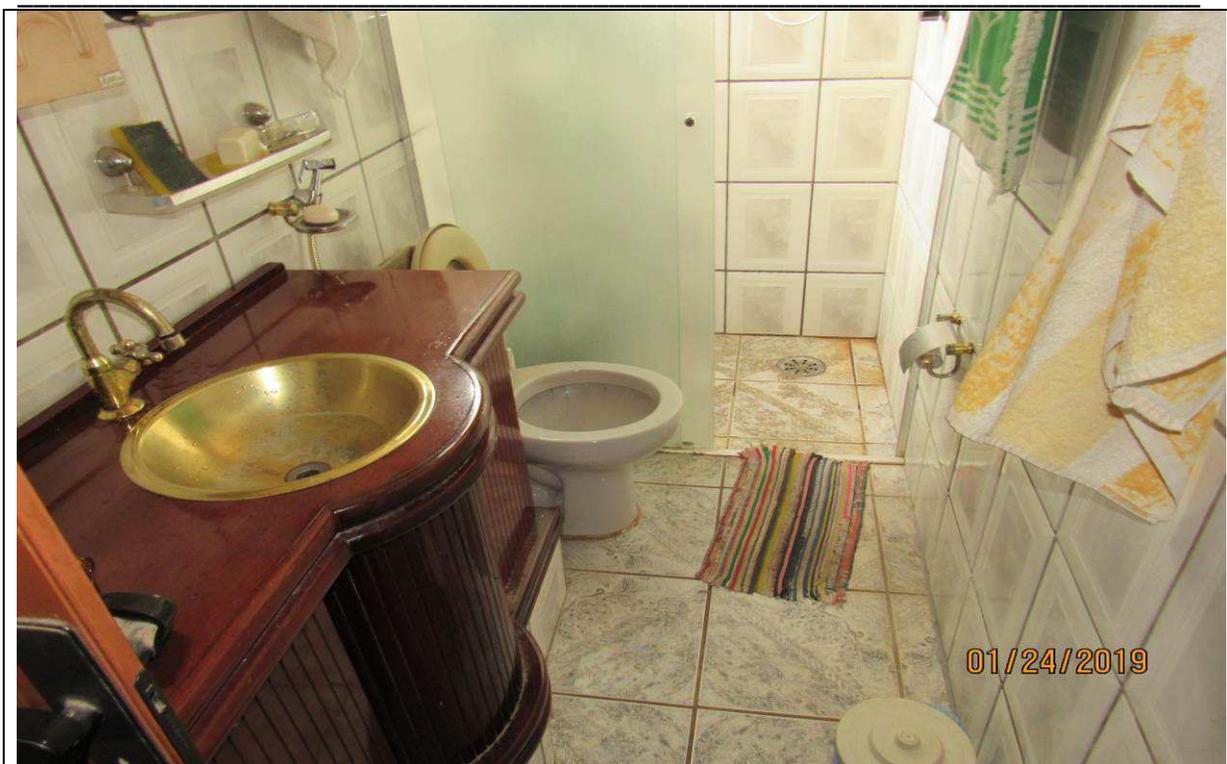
Vista geral do banheiro na suíte do imóvel.
